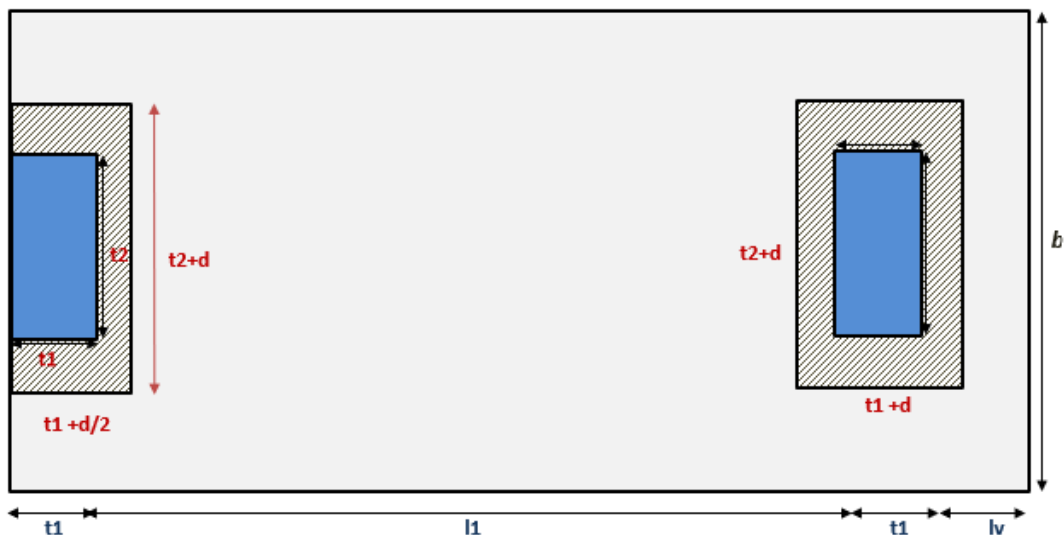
Detalle en planta de la zapata combinada Eje (3-4)/ B. Elaborada por la autora.
